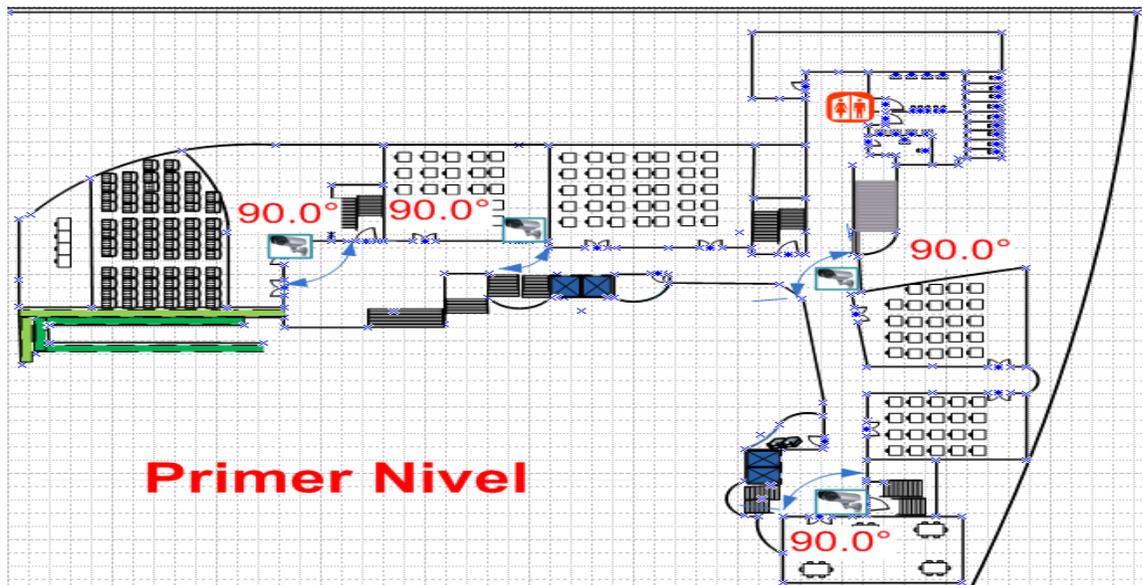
Ubicación de cámaras primer nivel pabellón de ingeniería.
